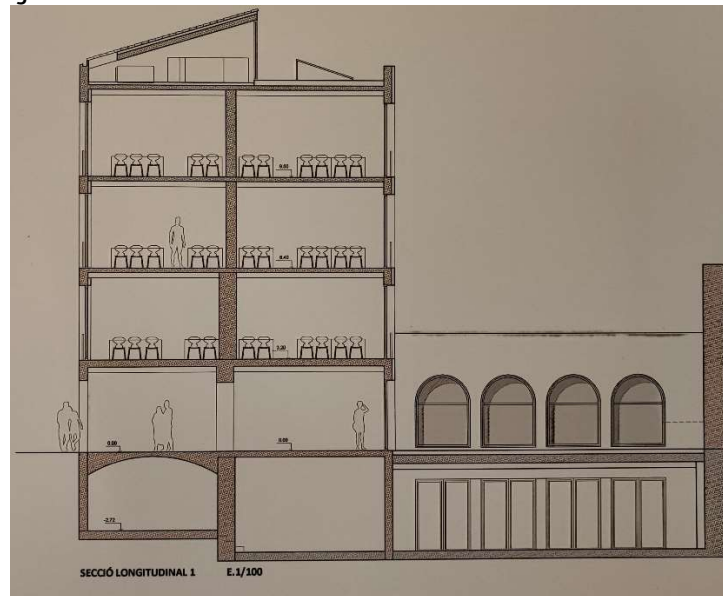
Detalle de zona de acceso a la planta baja por calle Costa de'n Macari nº 6 en SECCIÓ LONGITUDINAL 1 (escala 1:100) en la lámina 2/2 de la documentación presentada por el licitador
